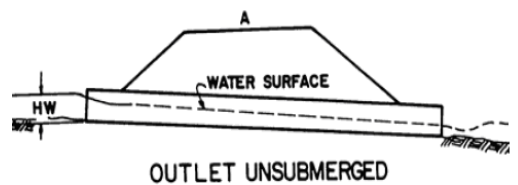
Alcantarilla - Control de Entrada
